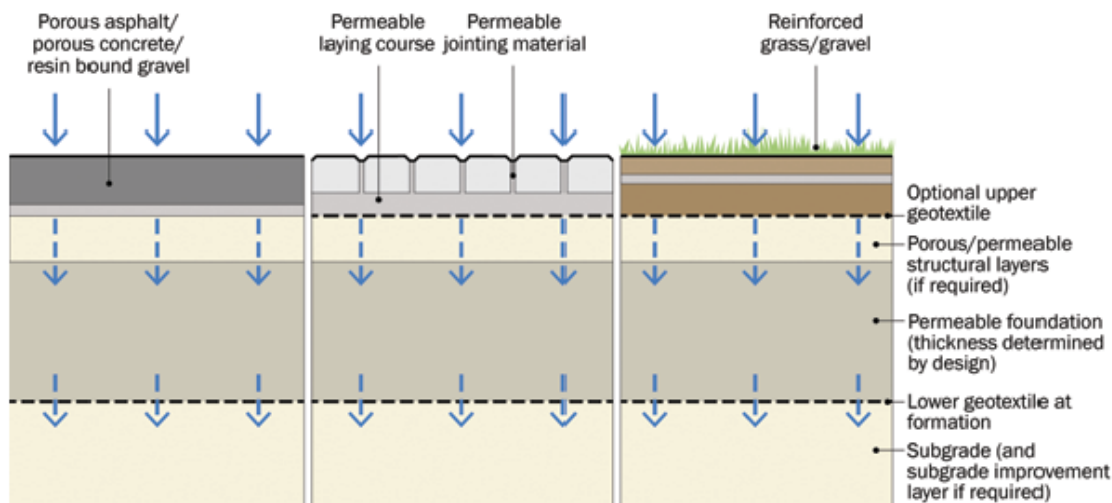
Sistema de infiltración total en la estructura de pavimento permeable-Tipo A. (Kellagher et al., 2015).
